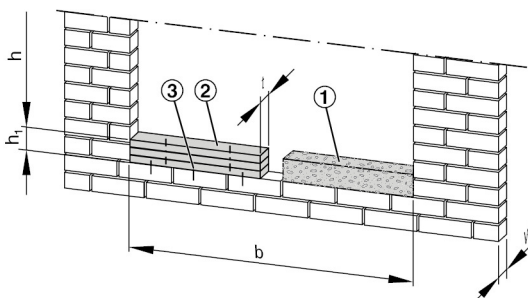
Einbauöffnung mit Auffütterung zur Höhenanpassung
